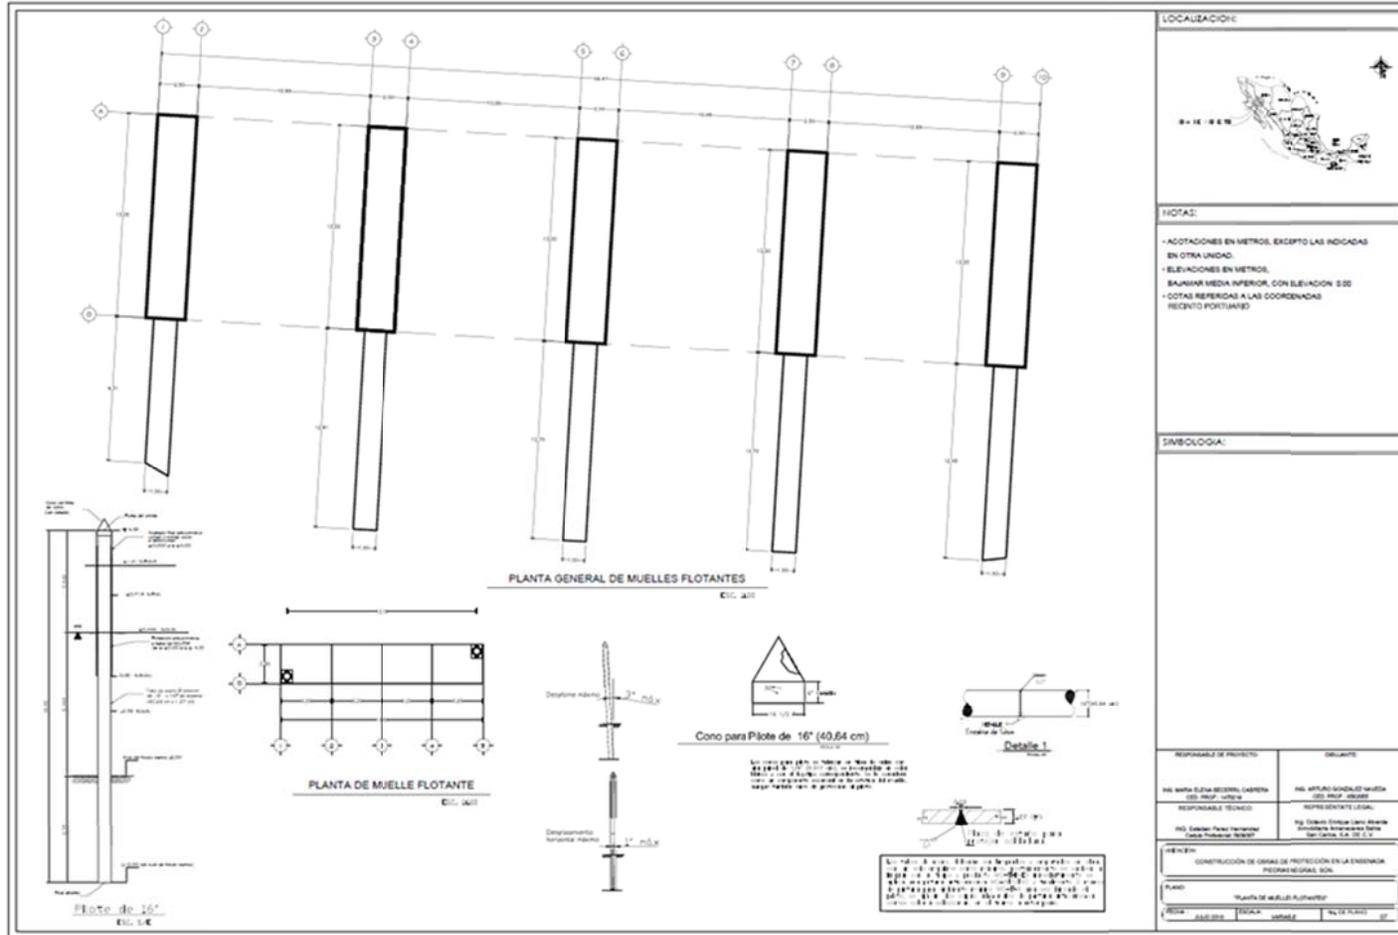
Planta general de muelles flotantes dentro del proyecto de construcción de obras de protección.
